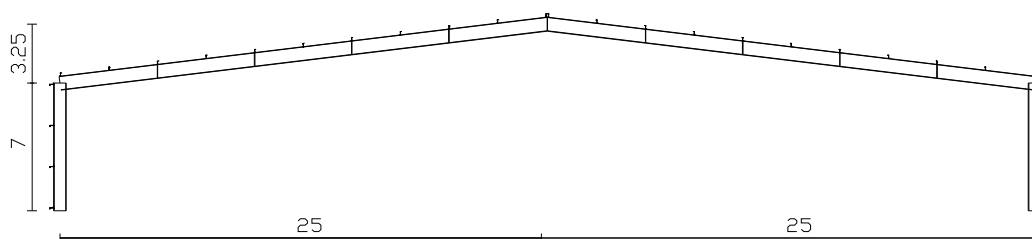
Pórtico rígido viga e pilar de alma cheia, vão de 50.00m
